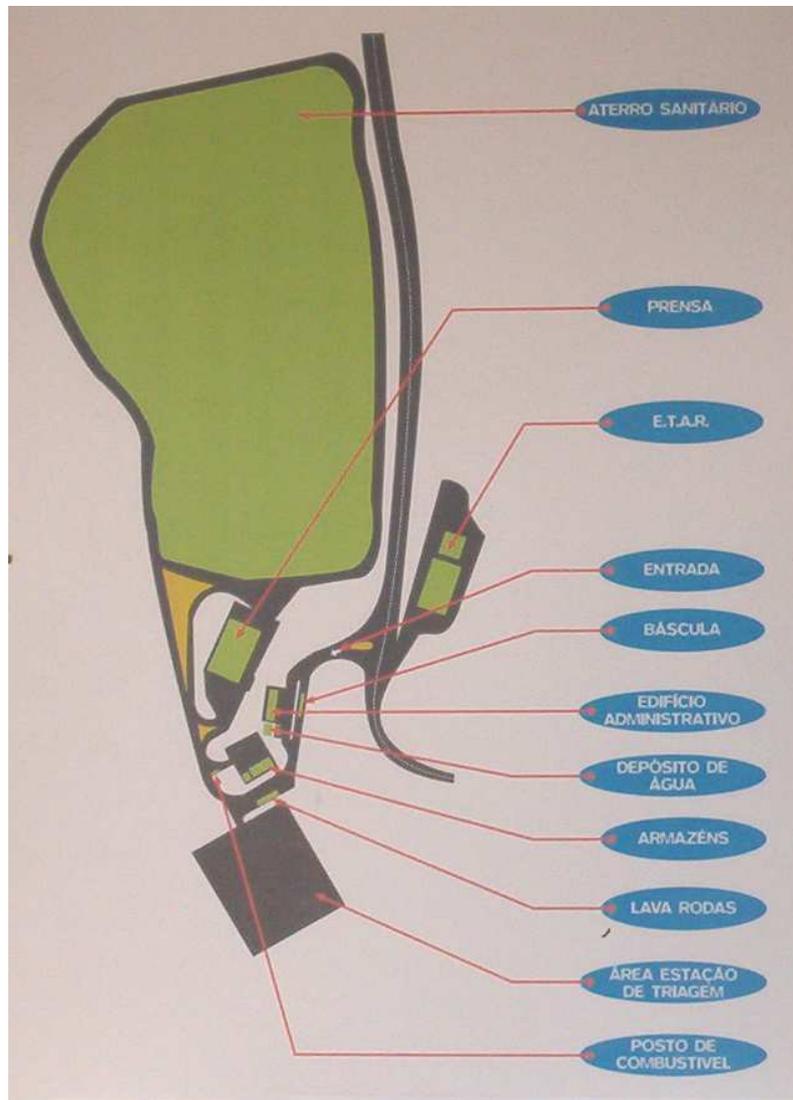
Esquema das infra-estruturas e instalações afetas ao aterro.
